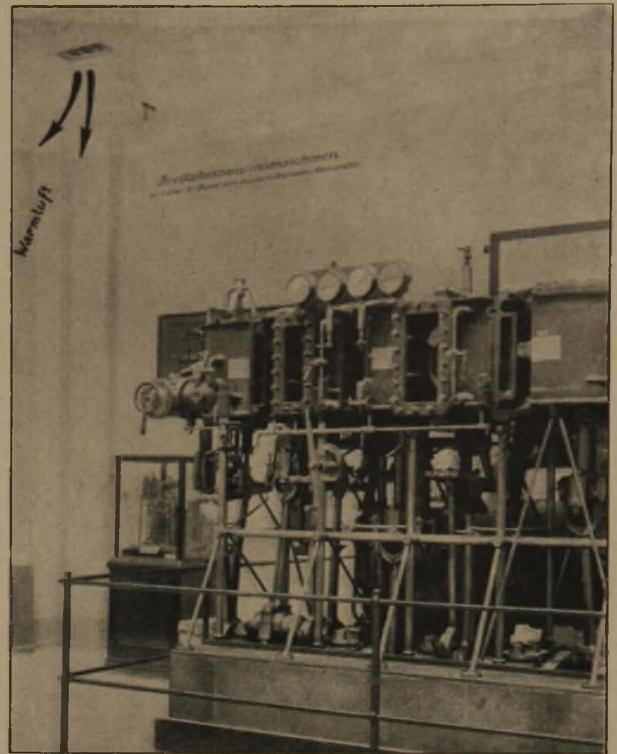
Östliche Seitenhalle mit Wärmeluft-Ausströmungsöffnung.
